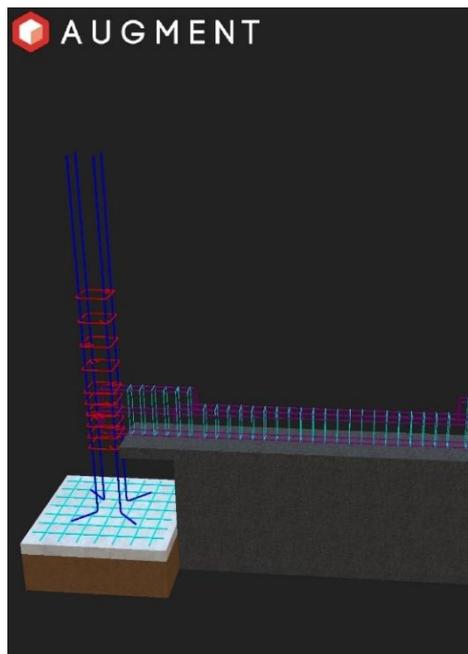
Modelo exportado a realidad aumentada de la distribución de aceros de zapata, columna con viga de cimentación.
